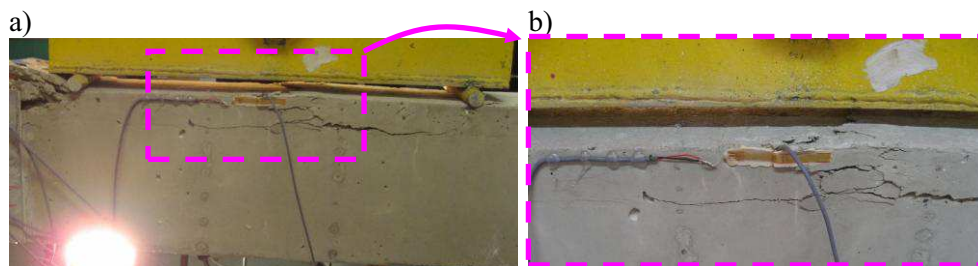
Poutre « R30-B-FI-P-TRC(5) » après rupture
